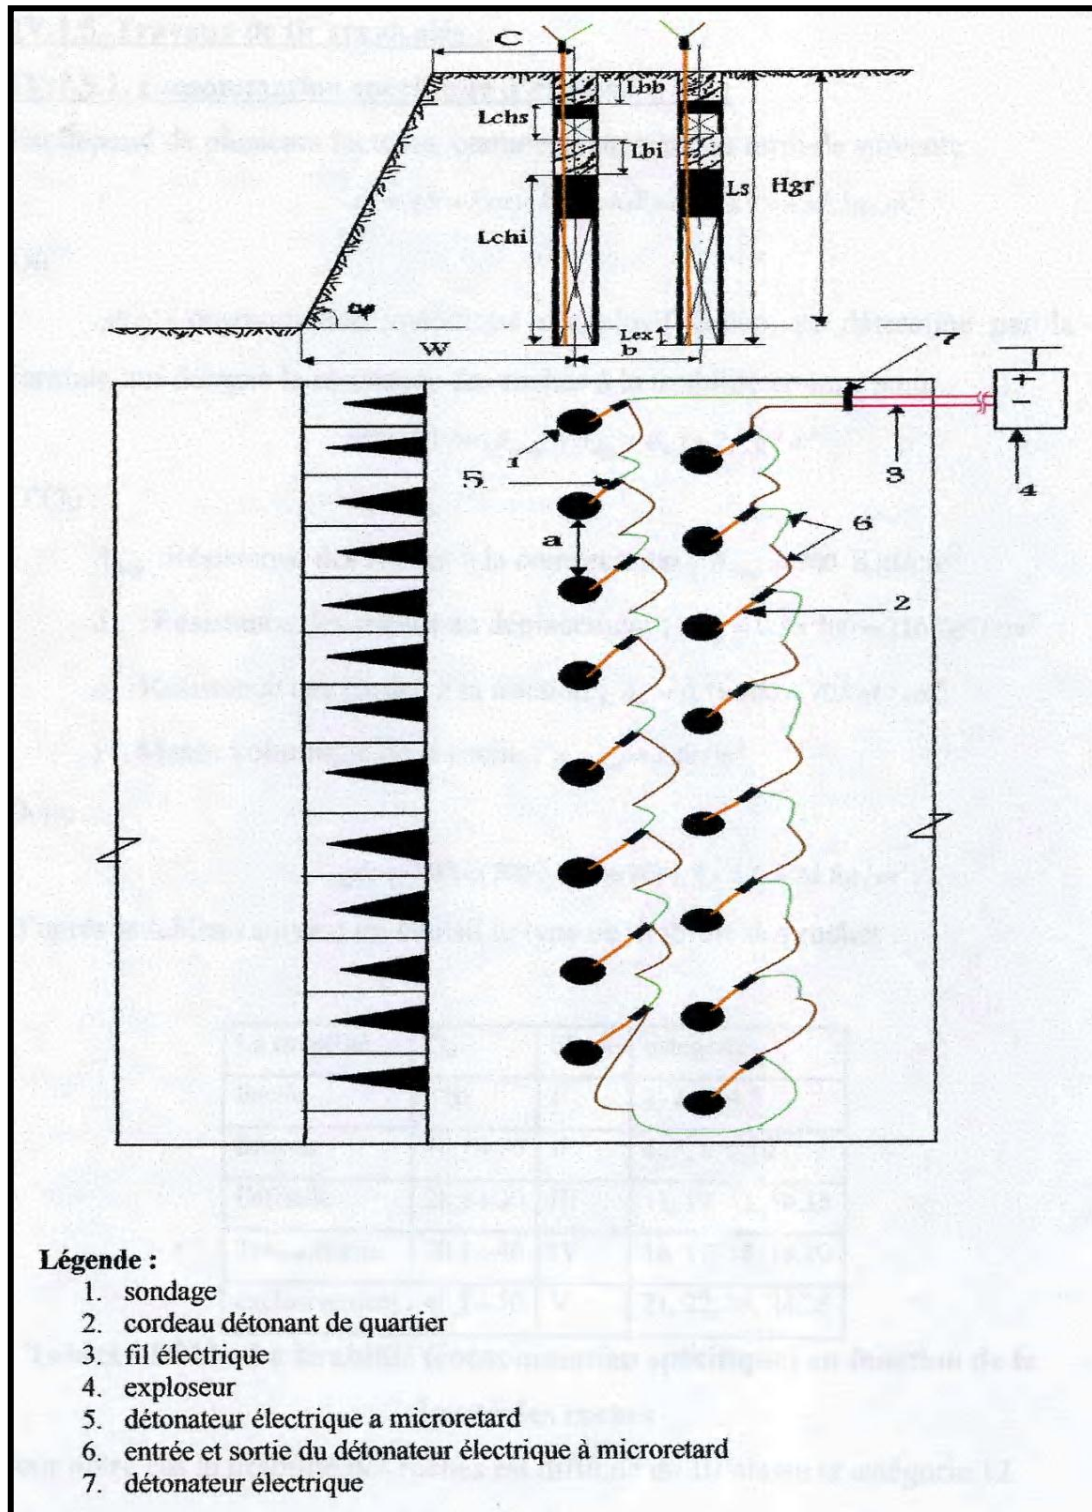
Plan de tir de la carrière de Ain-Touta
